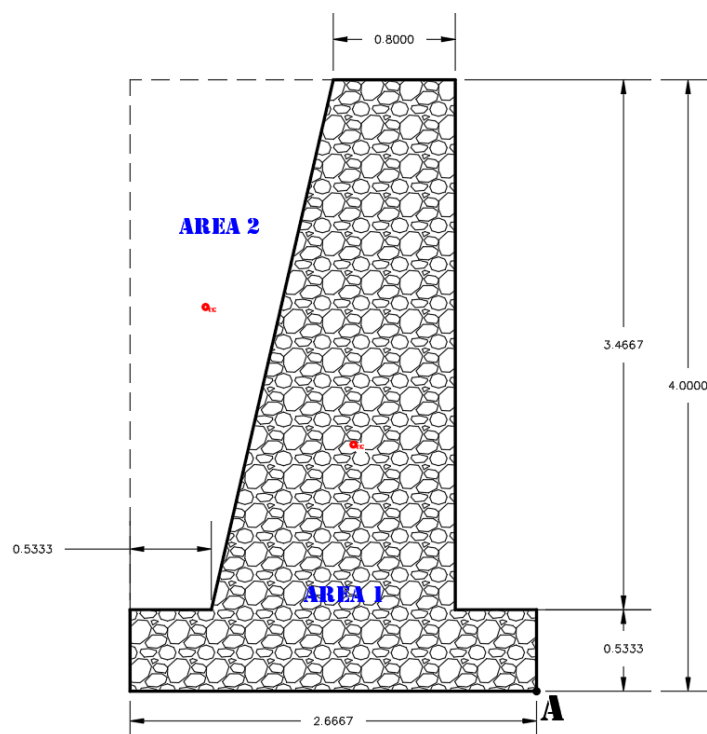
Dimensiones de muro de hormigón ciclópeo (h=4m)
